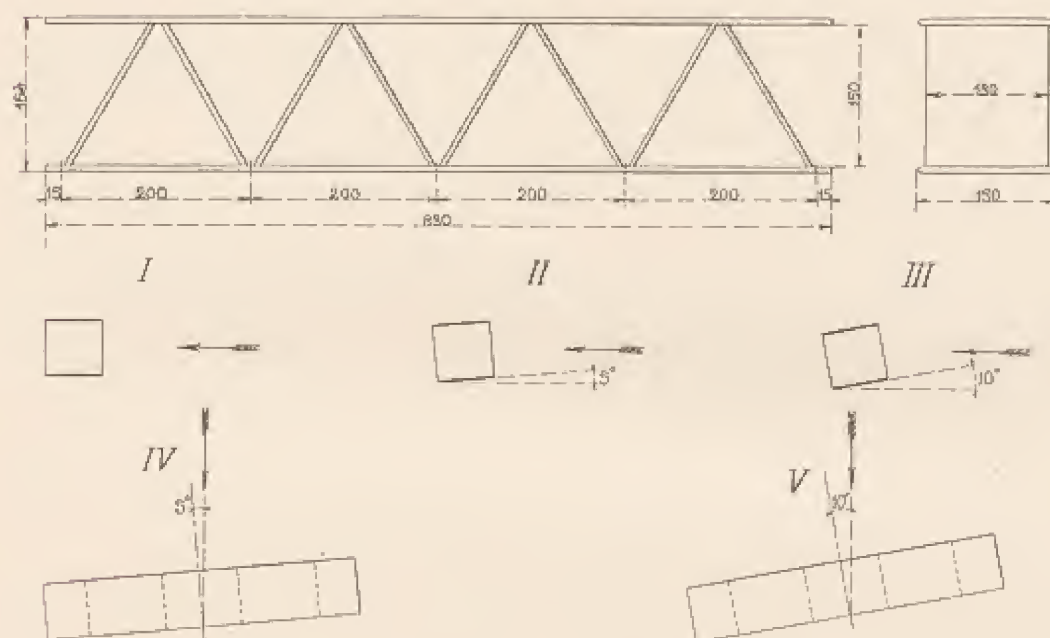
Poutre Fabre, et son orientation dans les essais.
